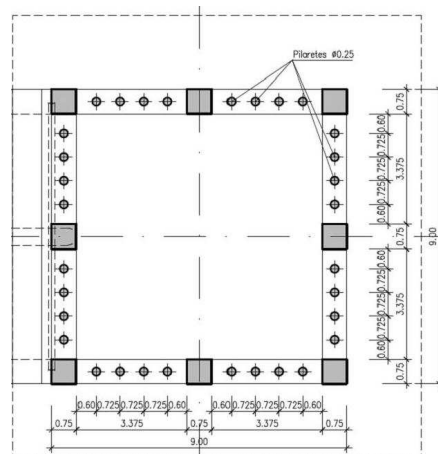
Esquema em planta da torre de tomada de água (retirado do Projecto de Execução; s/ escala).
